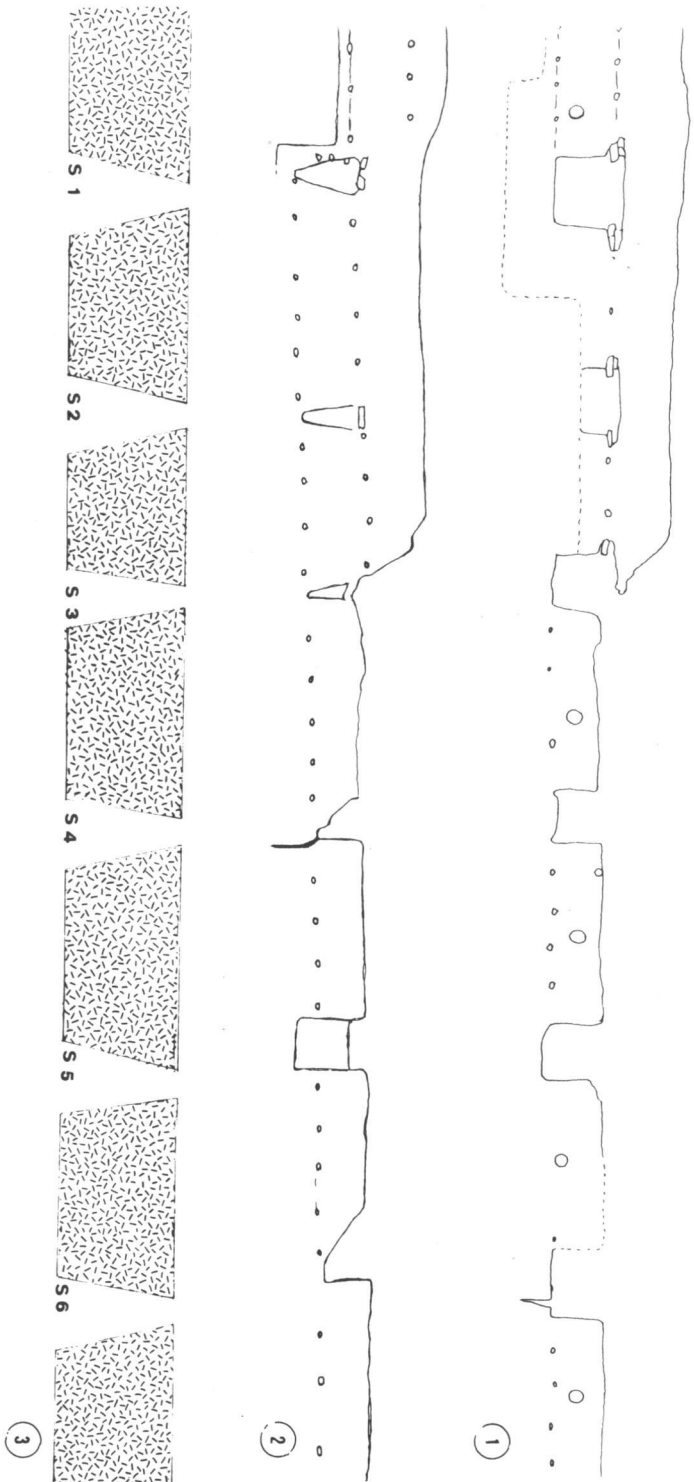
Muro I de la barbacana de la calle de la Faz; (1) alzado interior; (2) alzado exterior; (3) planta.
